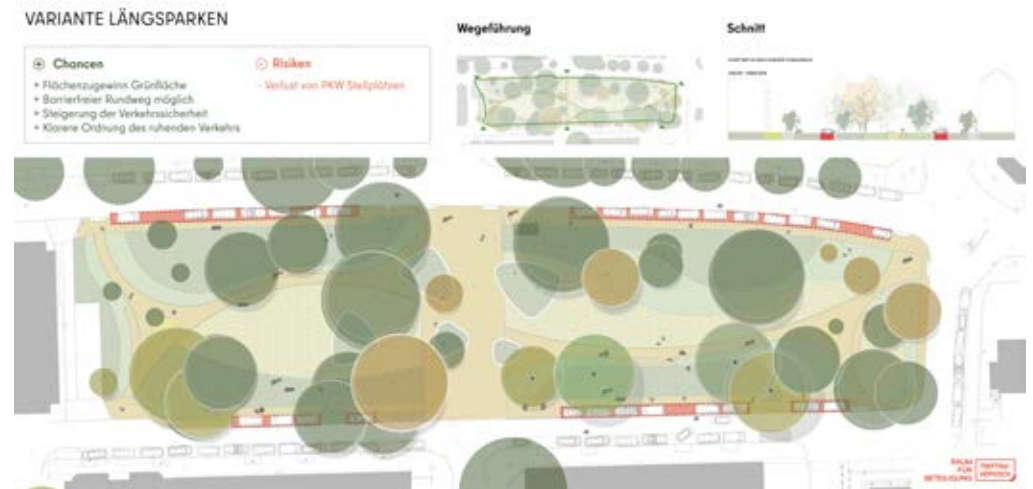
Variante 1 - Längsparken: Lageplan, Wegeführung, Schnitt
